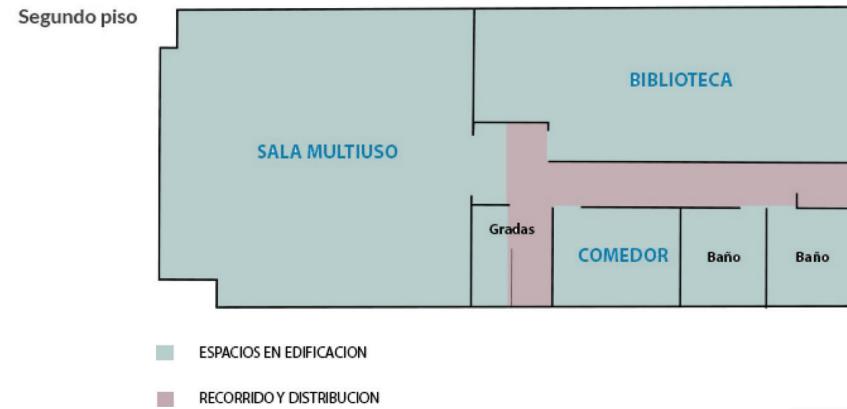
Diagrama de recorridos en áreas de la edificación #1 - Planta Alta.
